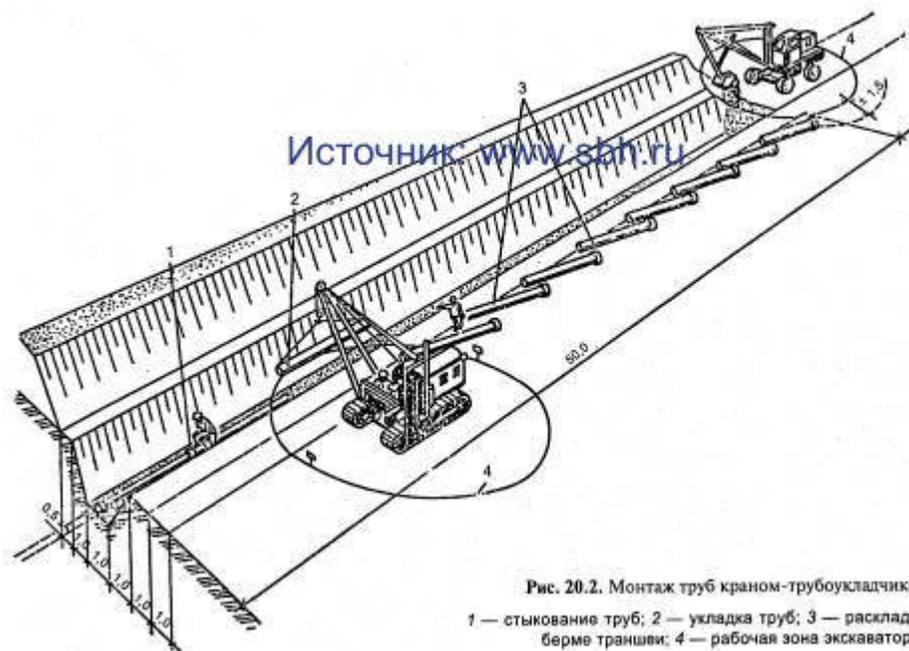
Монтаж труб краном-трубоукладчиком:
